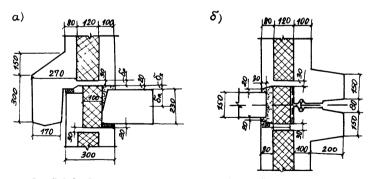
Стики трехслойной керамантобетонной панели: а - горизонтальный; б - вертикельный
